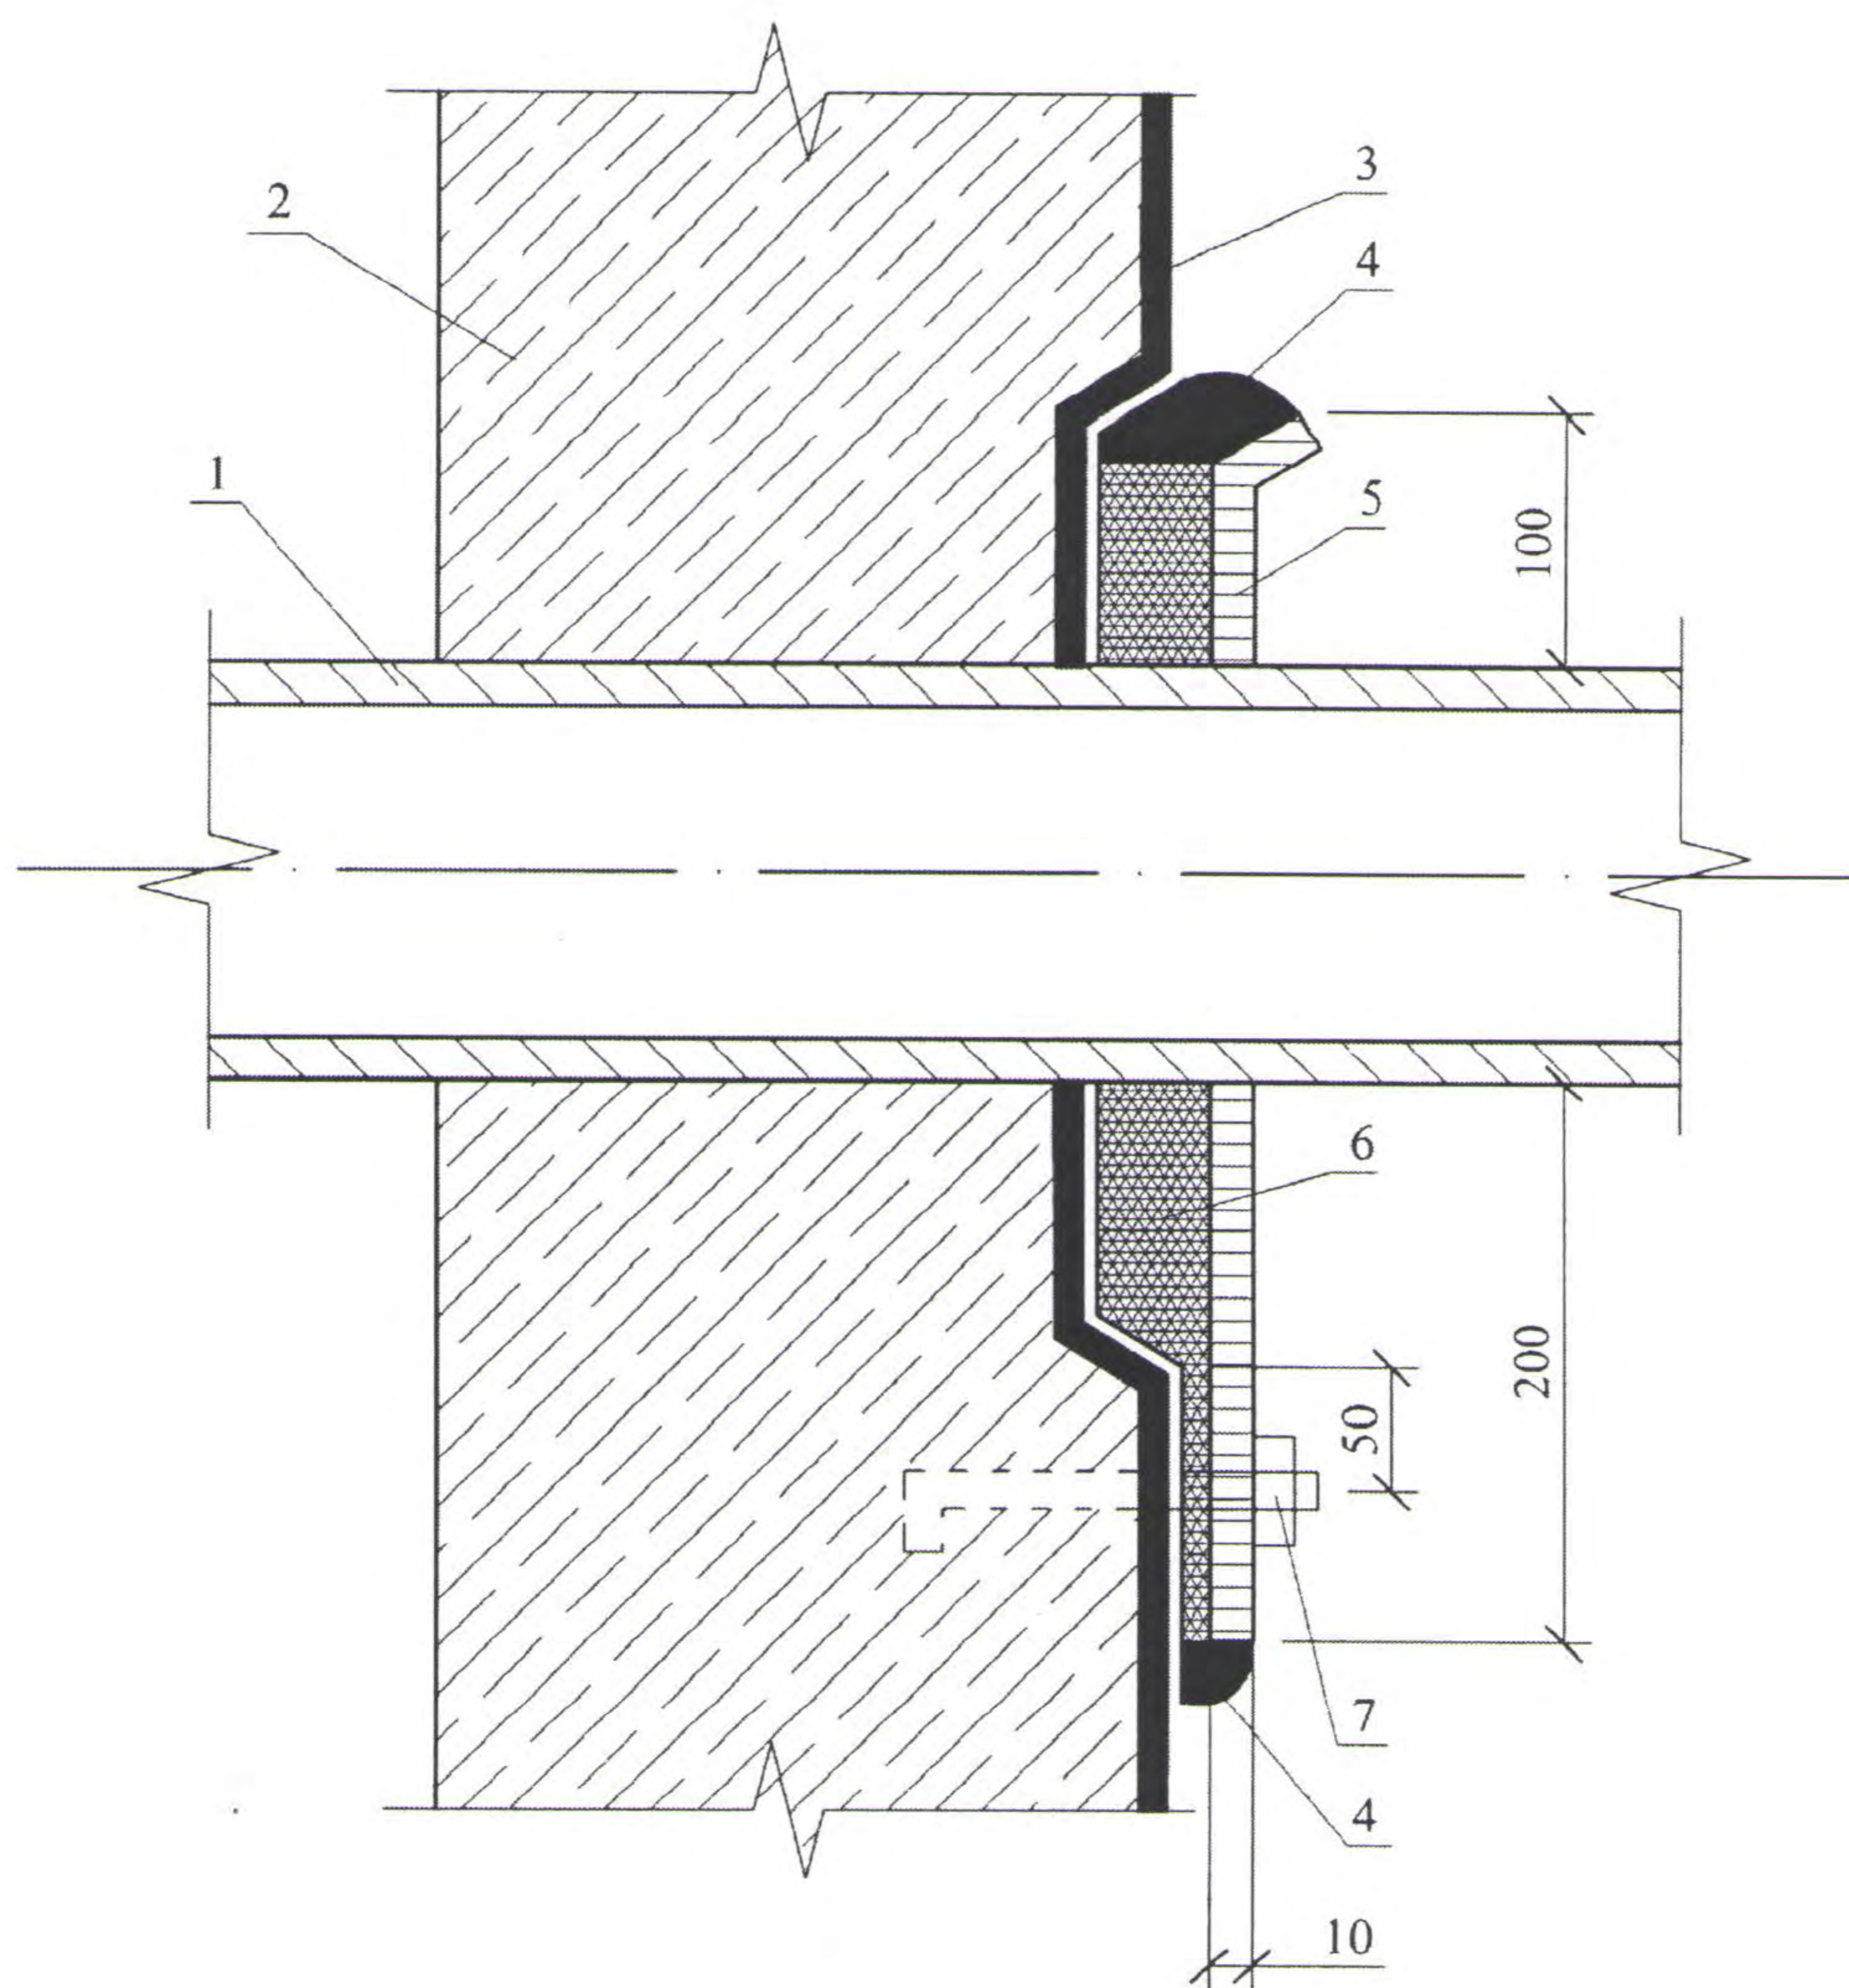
Примыкание гидроизоляции проходящей через стену к трубе
